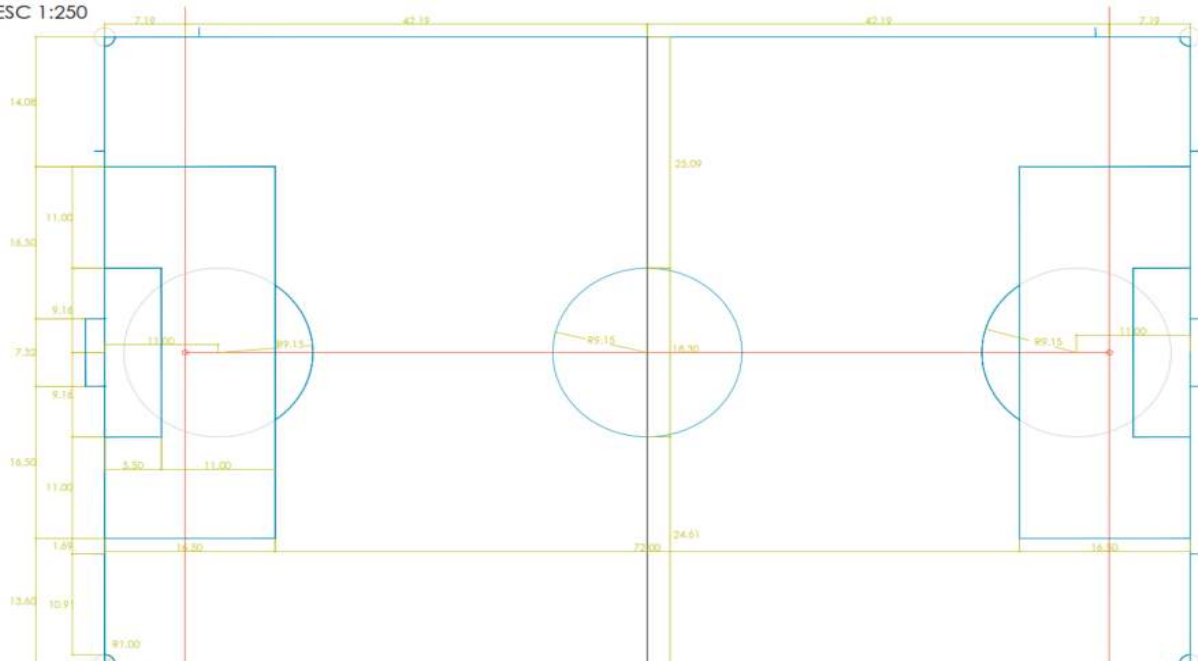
Planta General Cancha de Fútbol Estadio Marino Klinger
